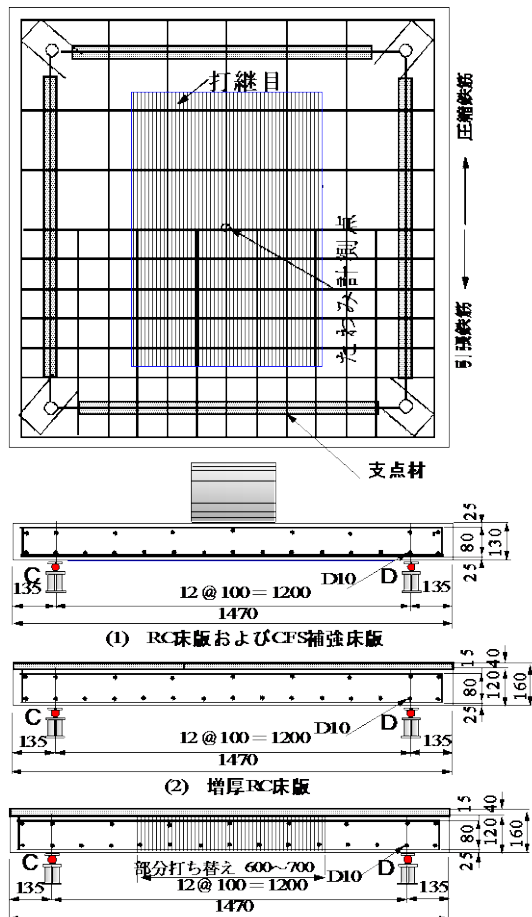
模擬床版供試体の寸法および鉄筋配置 (mm)
